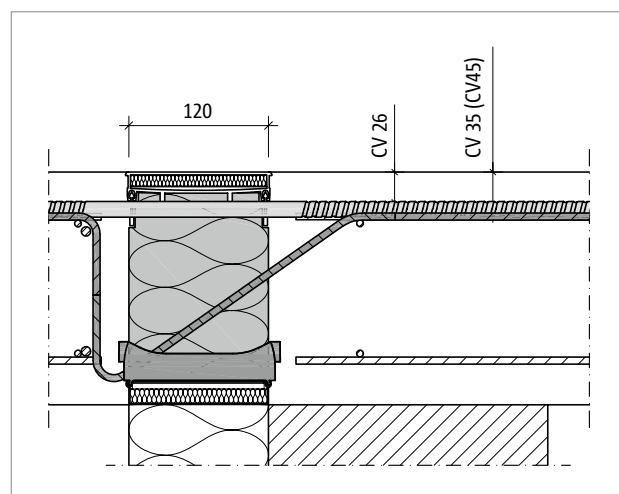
Schöck Isokorb® CXT typ KL: Napojovací stavební výztuž u přímého uložení
